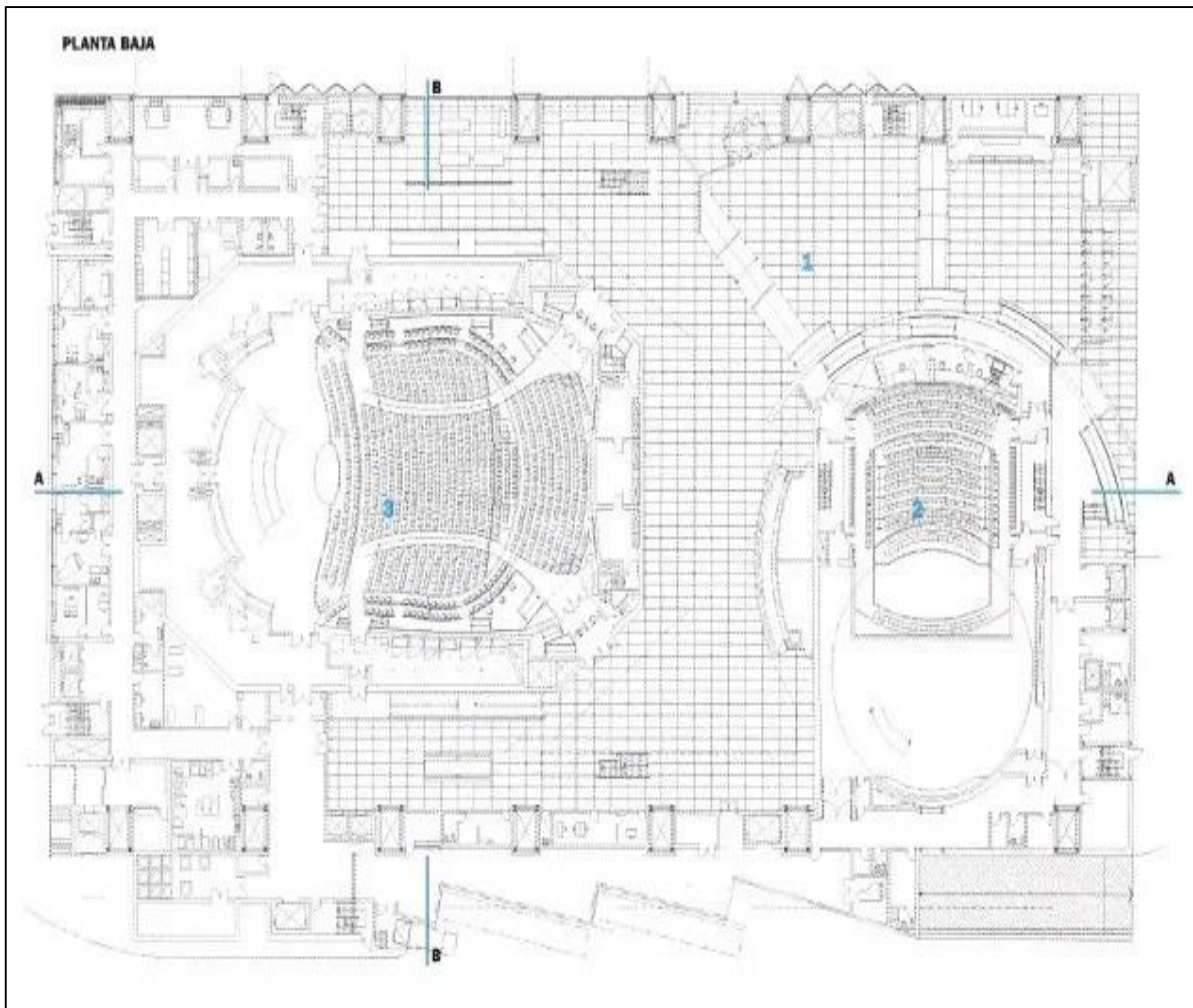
Planta Baja del Centro Kimmel para las Artes Escénicas.
